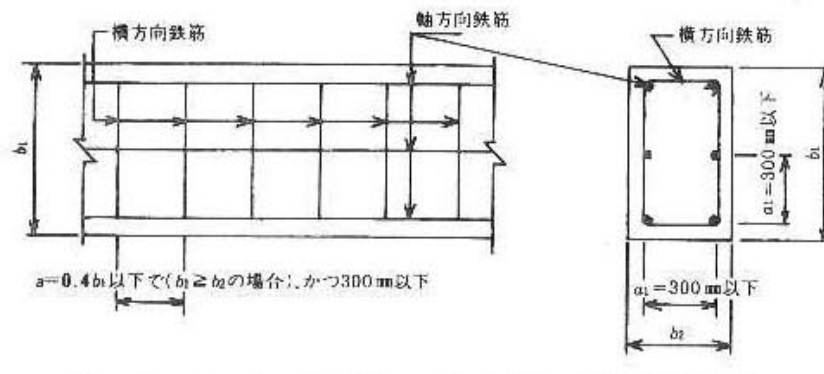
ねじりモーメントに対する鉄筋の配置
